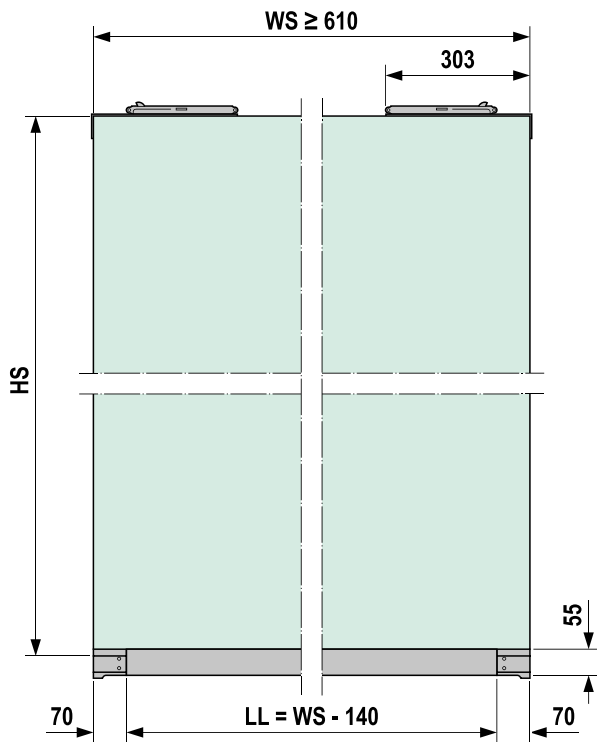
/ Fig. 9 / Fig. 9: Met afwateringsprofiel / Con profilo di drenaggio / Con perfil de drenaje
